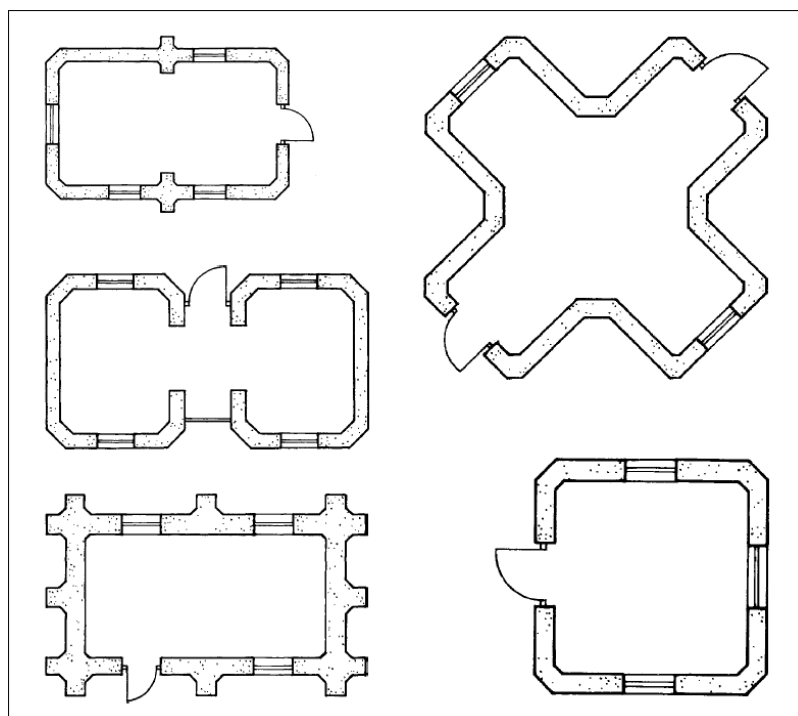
Propuestas de plantas diseñadas con elementos angulares.
